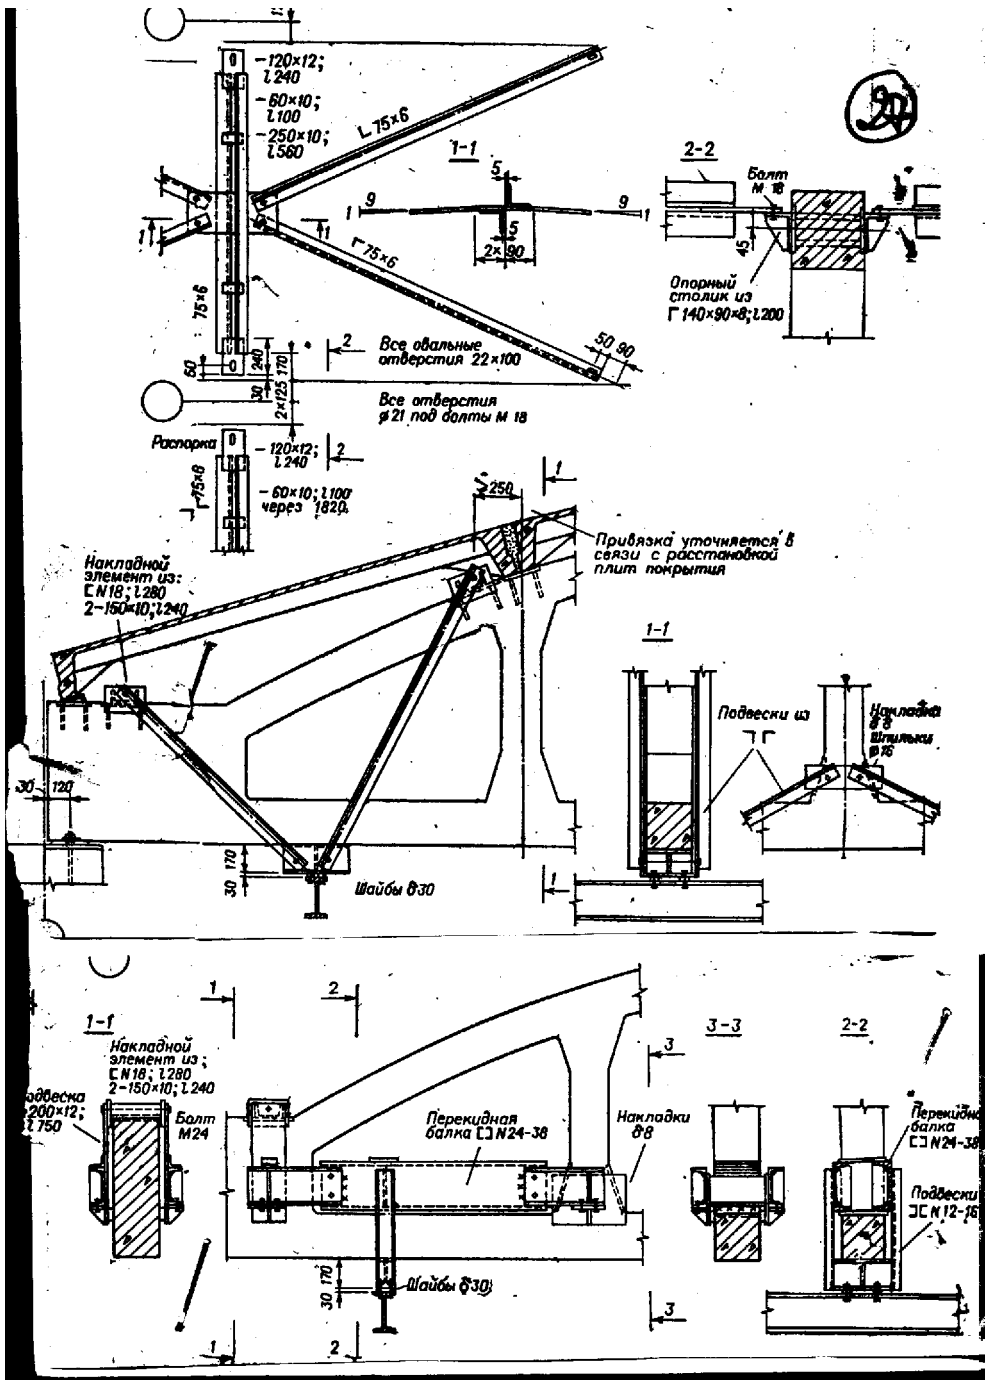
Связи в покрытиях при железобетонных фермах:
